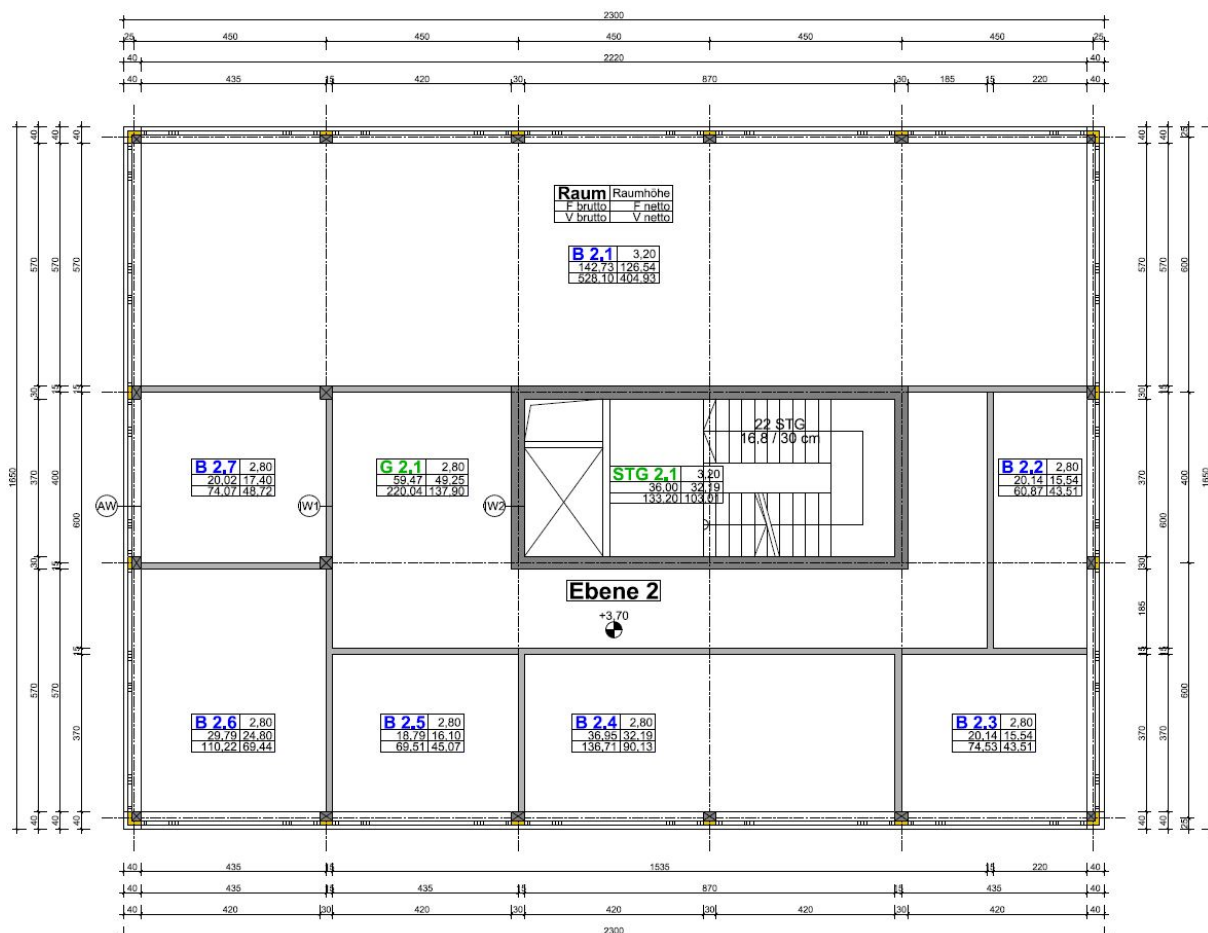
Grundriss Gebäude (Stumpf, 2011)
